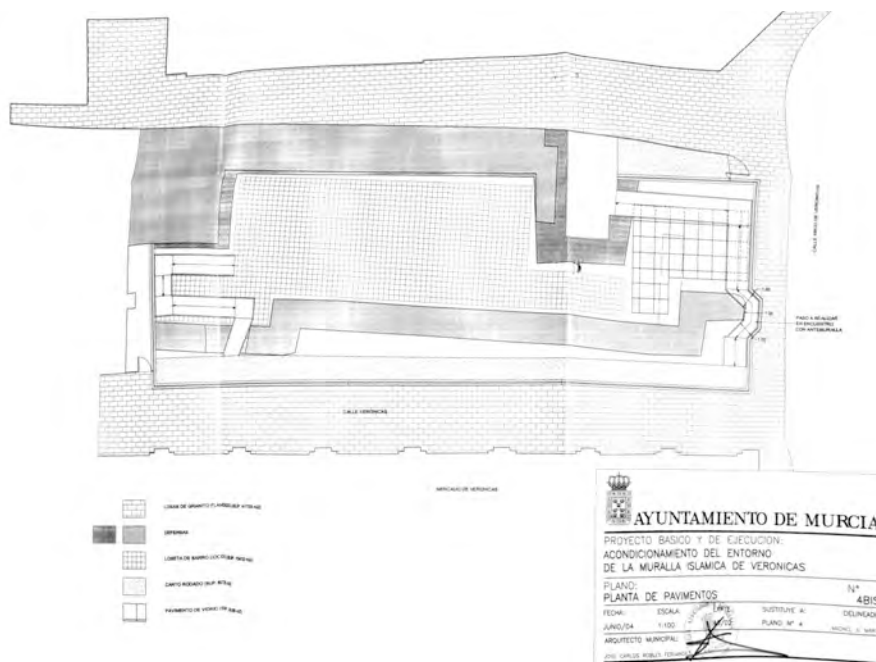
Planimetría de la intervención. (Robles, 2000)
